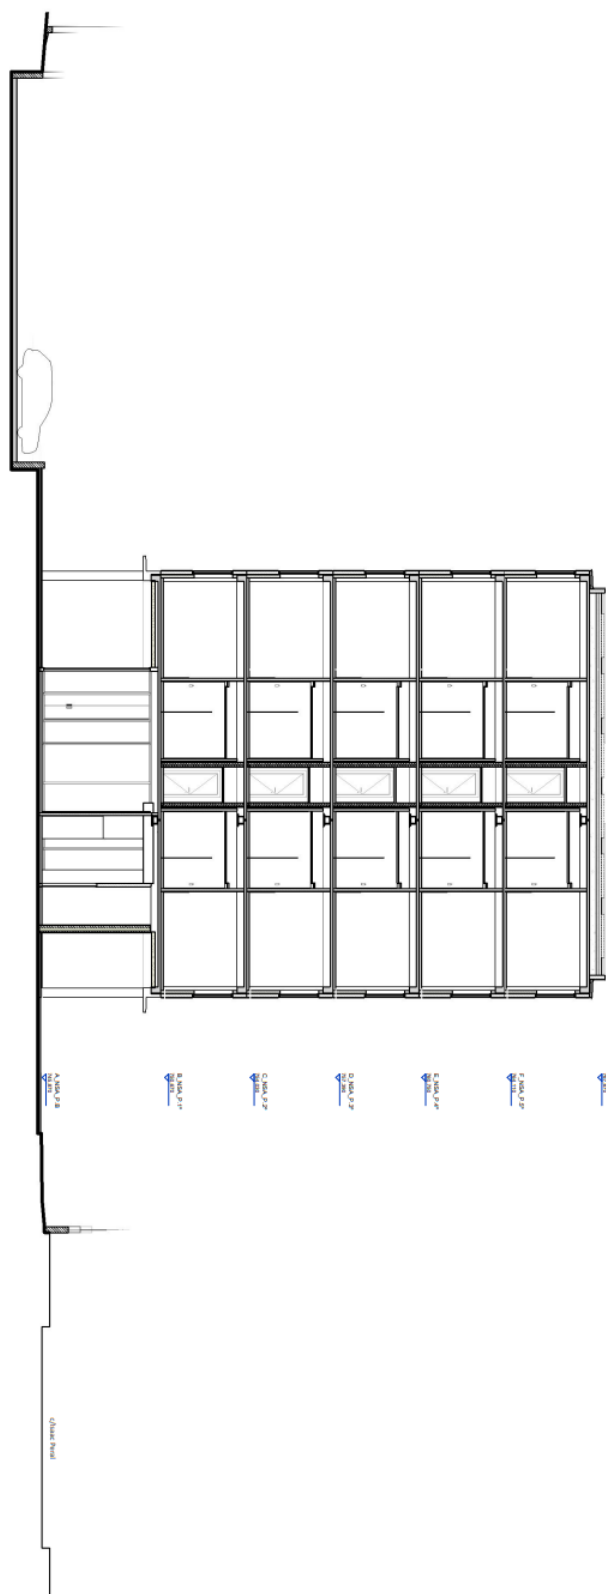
Corte transversal - Hotel "Tres Cantos" em Madrid (sem escala)
